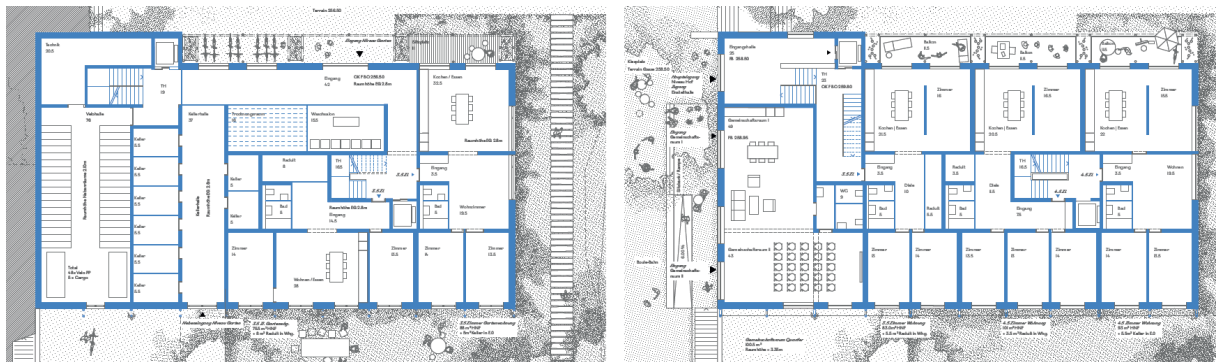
Grundrisse Gassengeschoss (links) und Gartengeschoss (rechts), ohne Masstab
